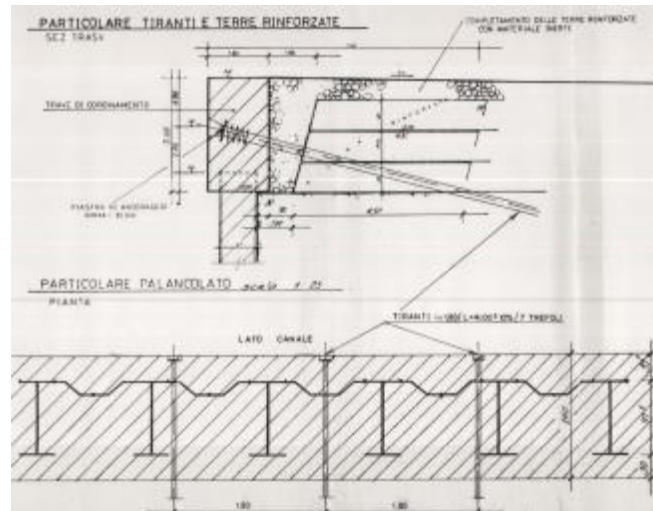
Stralcio planimetrico del banchinamento e particolare terre armate.
